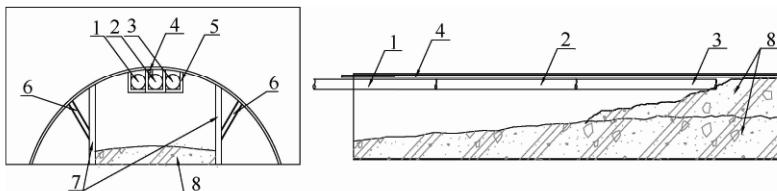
顶进钢管内混凝土浇筑设施布置示意图
